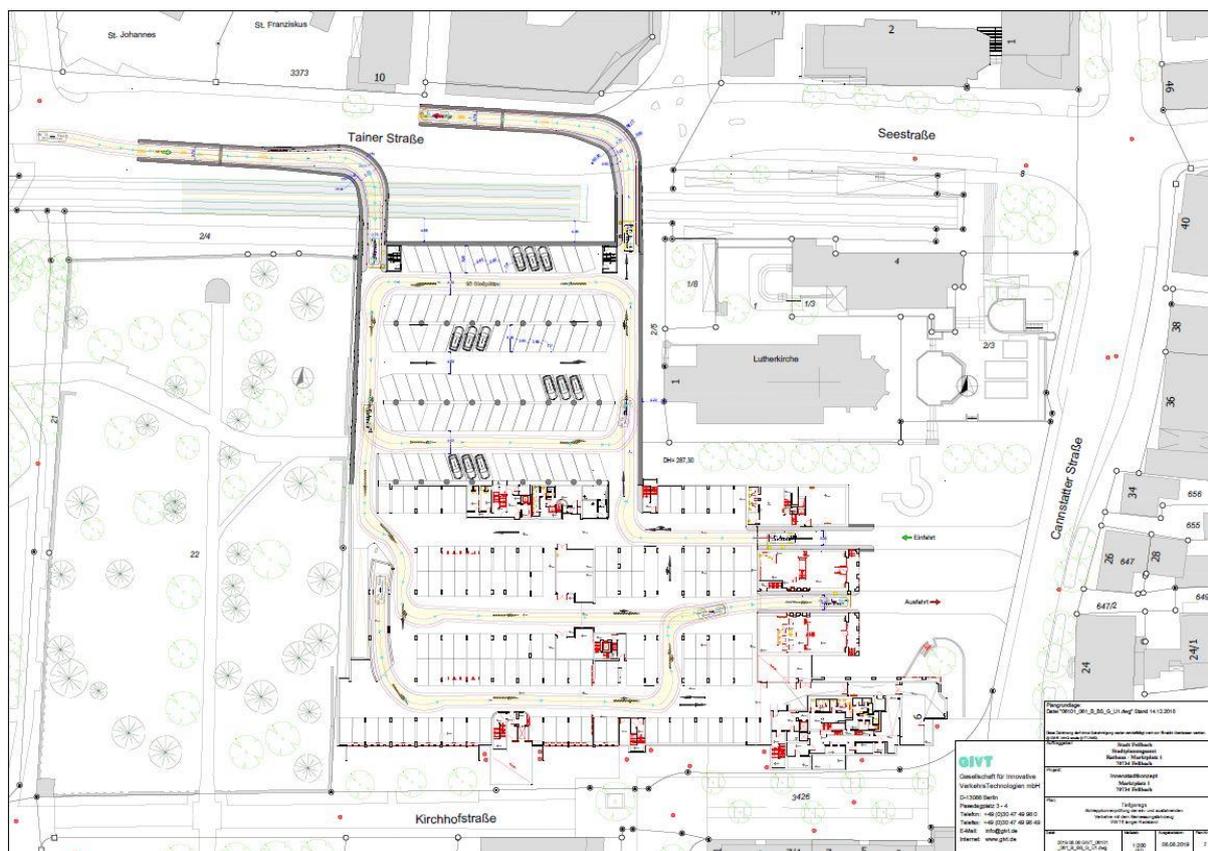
Tiefgaragenzufahrt Planfall 5
